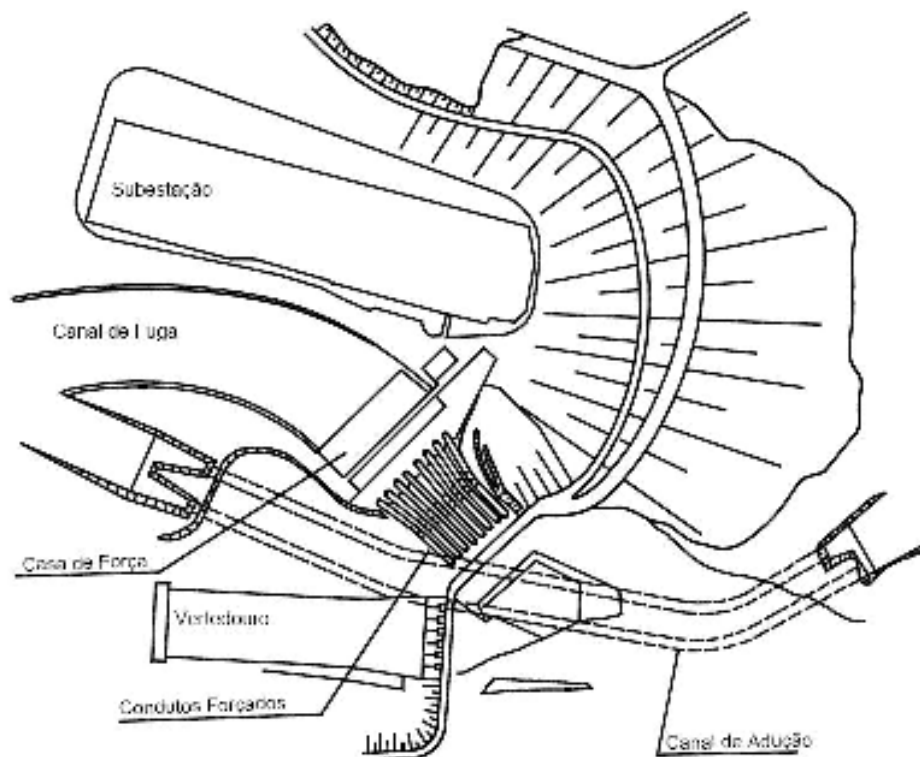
arranjo geral em planta baixa da UHE Furnas (HASPARYK, 2005)
